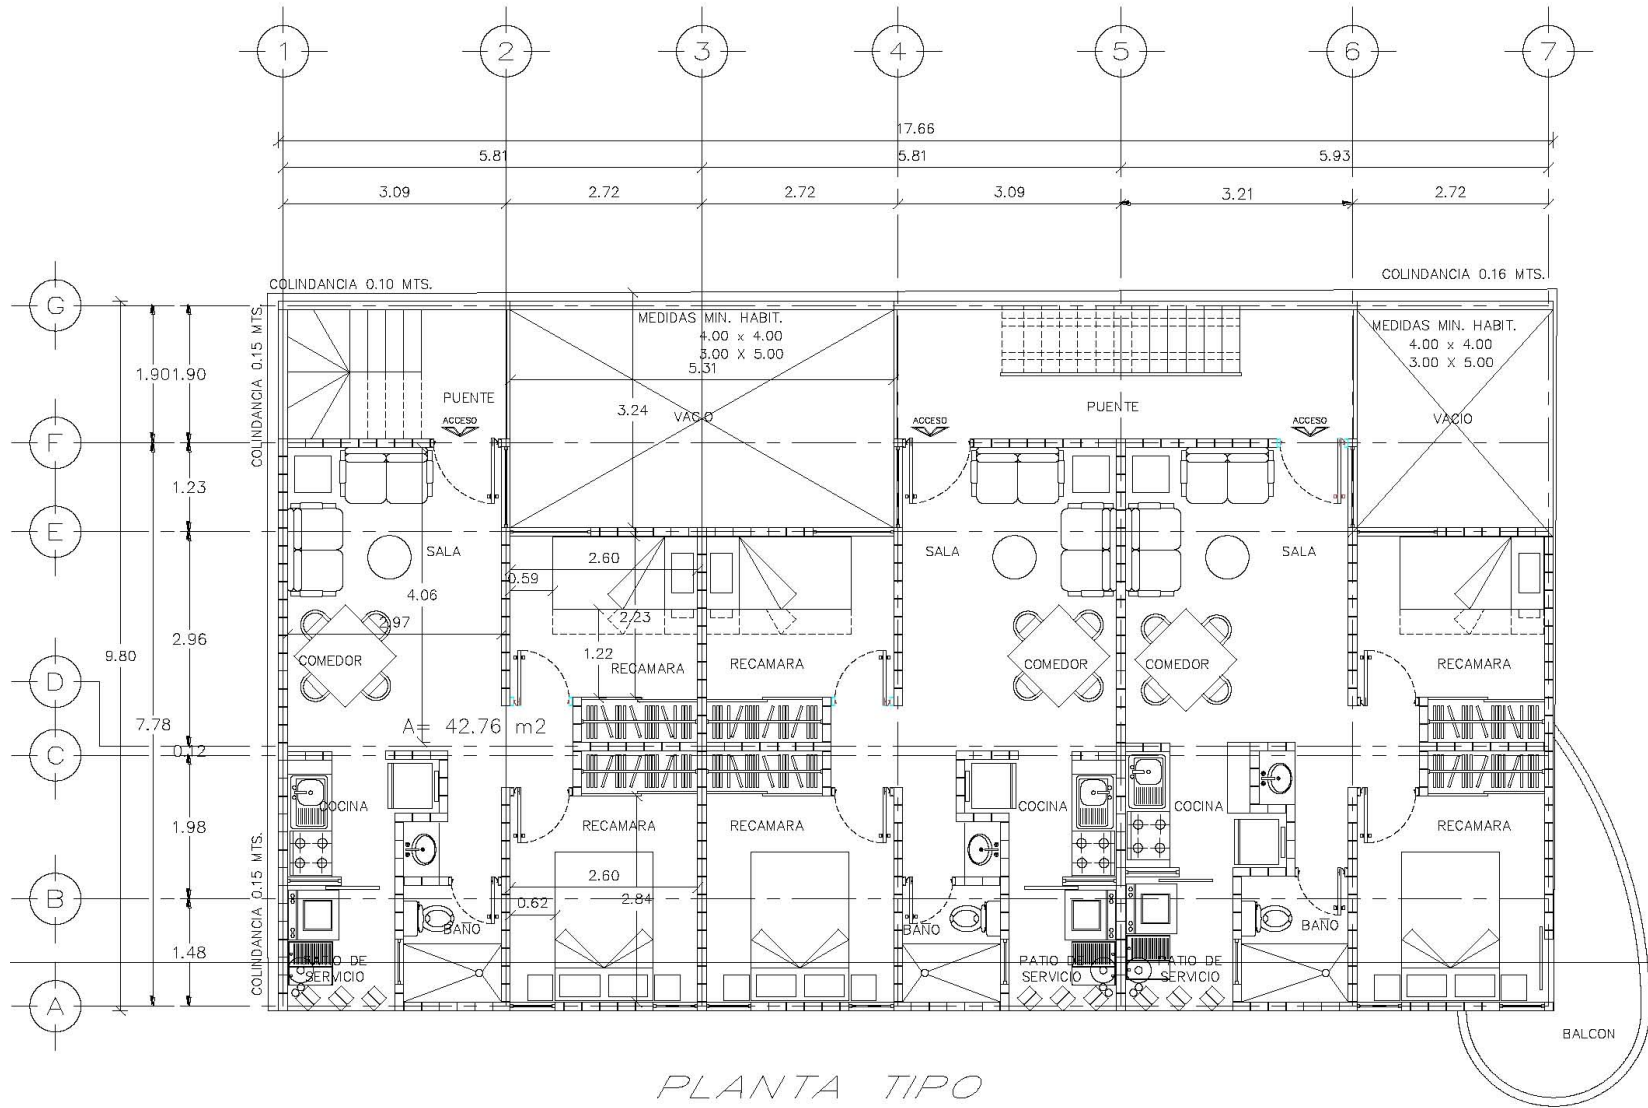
Plano arquitectónico de la planta tipo (2, 3, 4, 5, 6 nivel).
